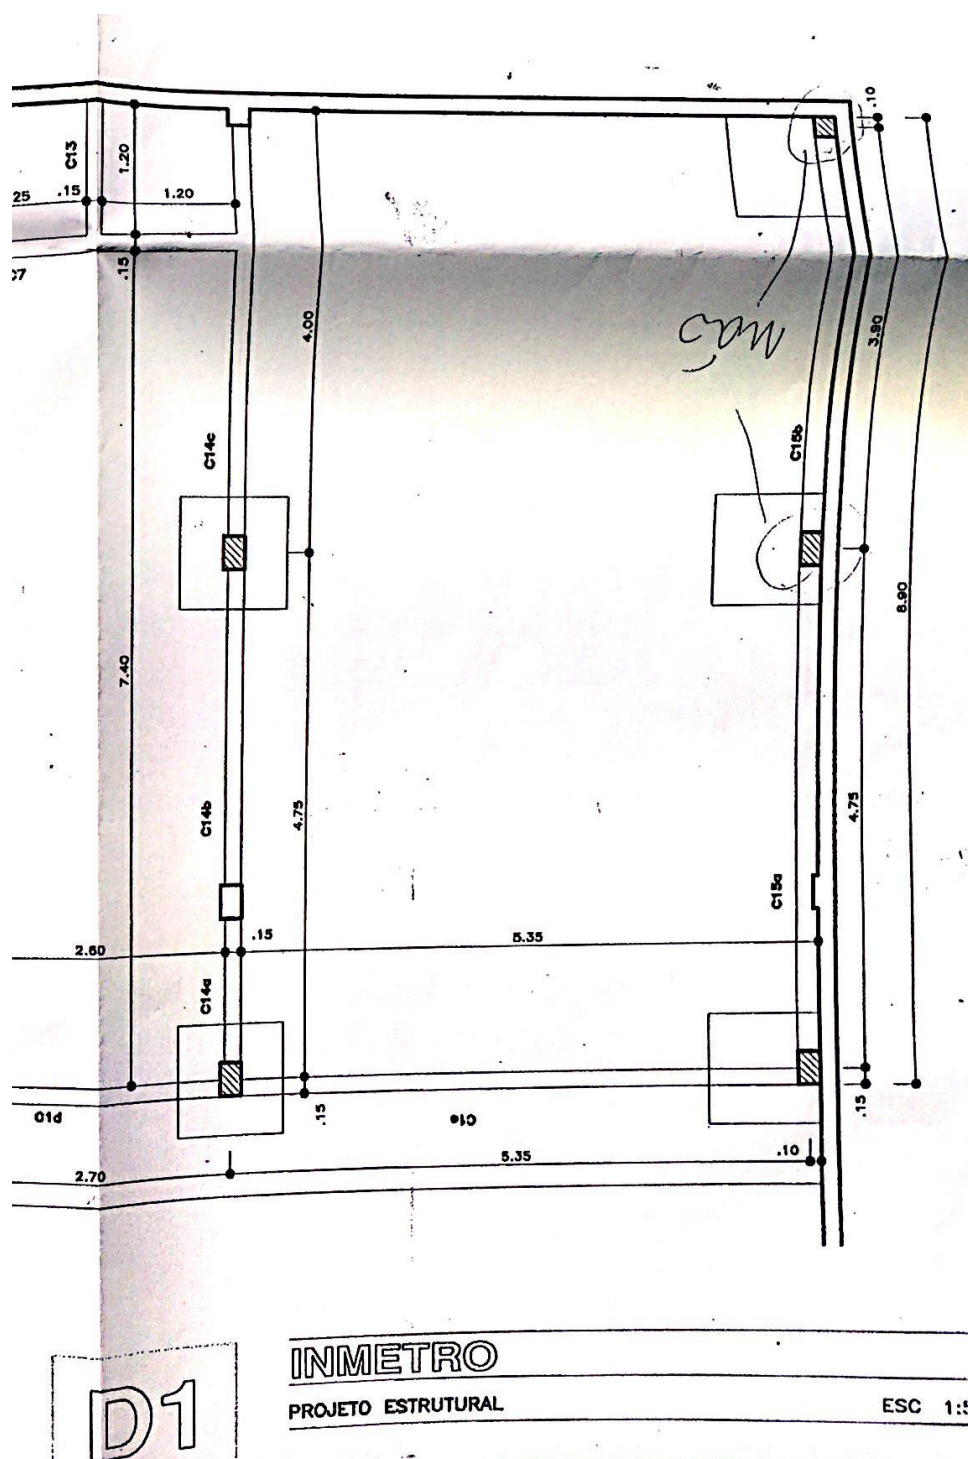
Planta Baixa das formas da fundação Ampliada – Região do Auditório – Edifício Anexo
